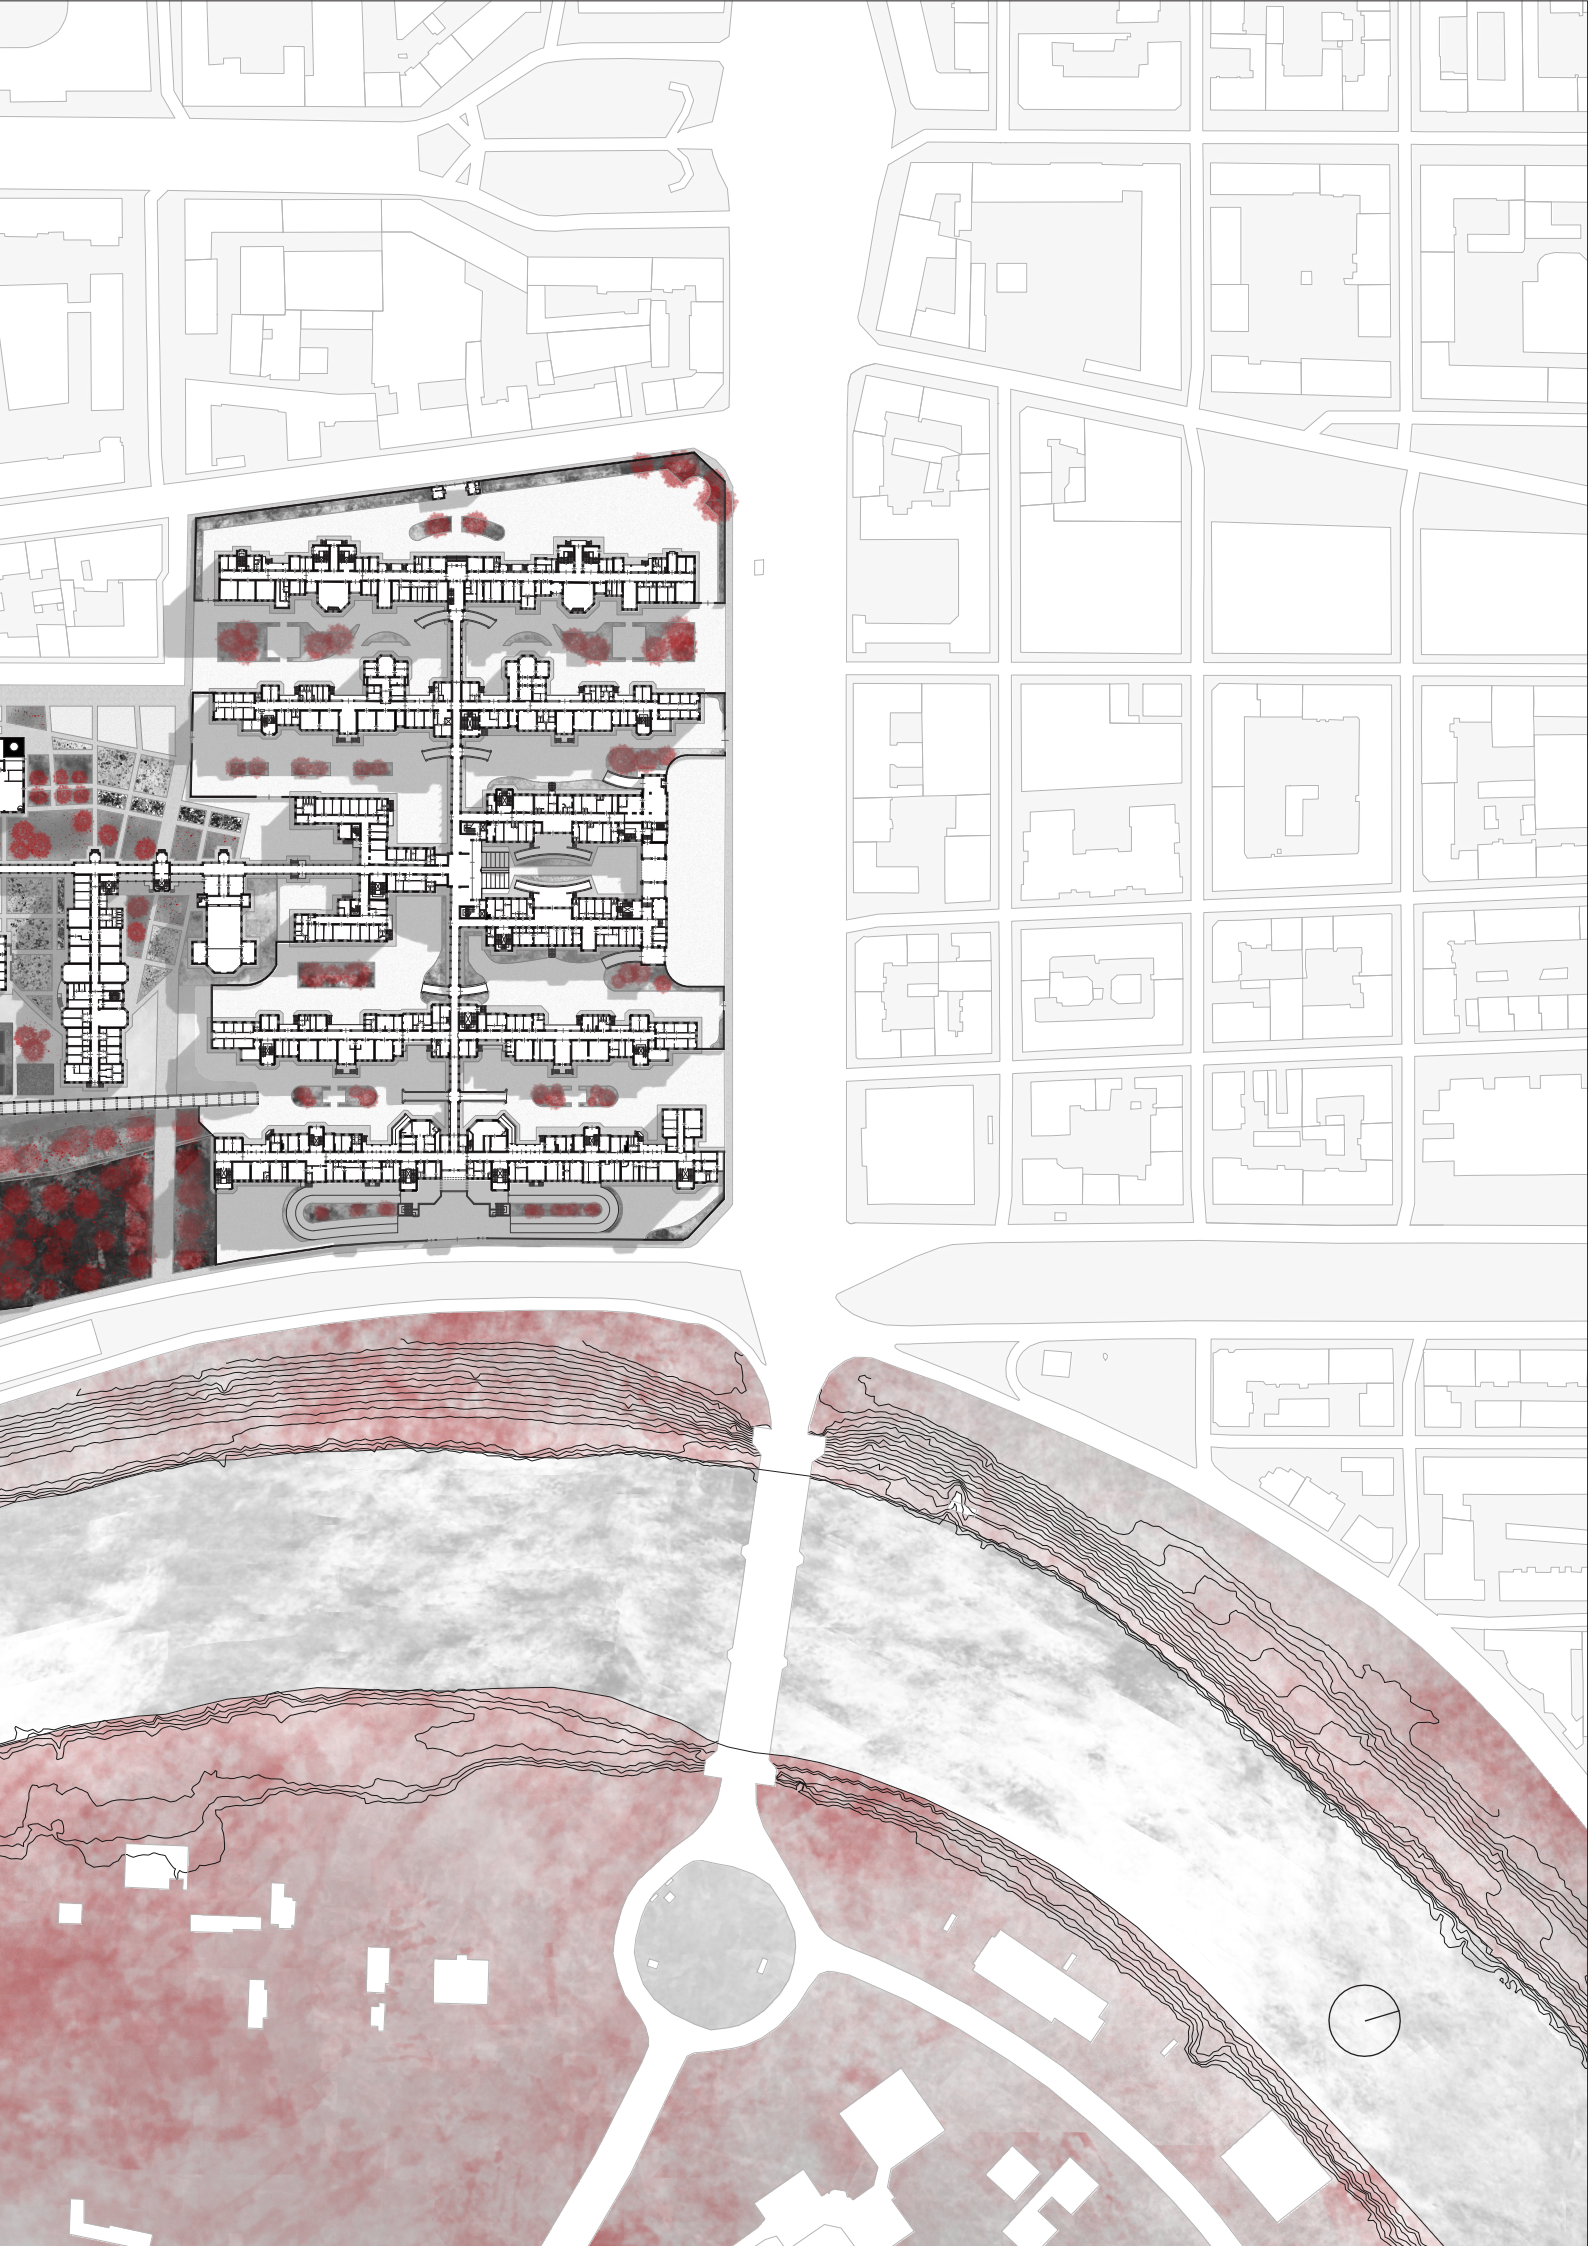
pianta piano rialzato, progetto delle aree esterne, fuori scala
